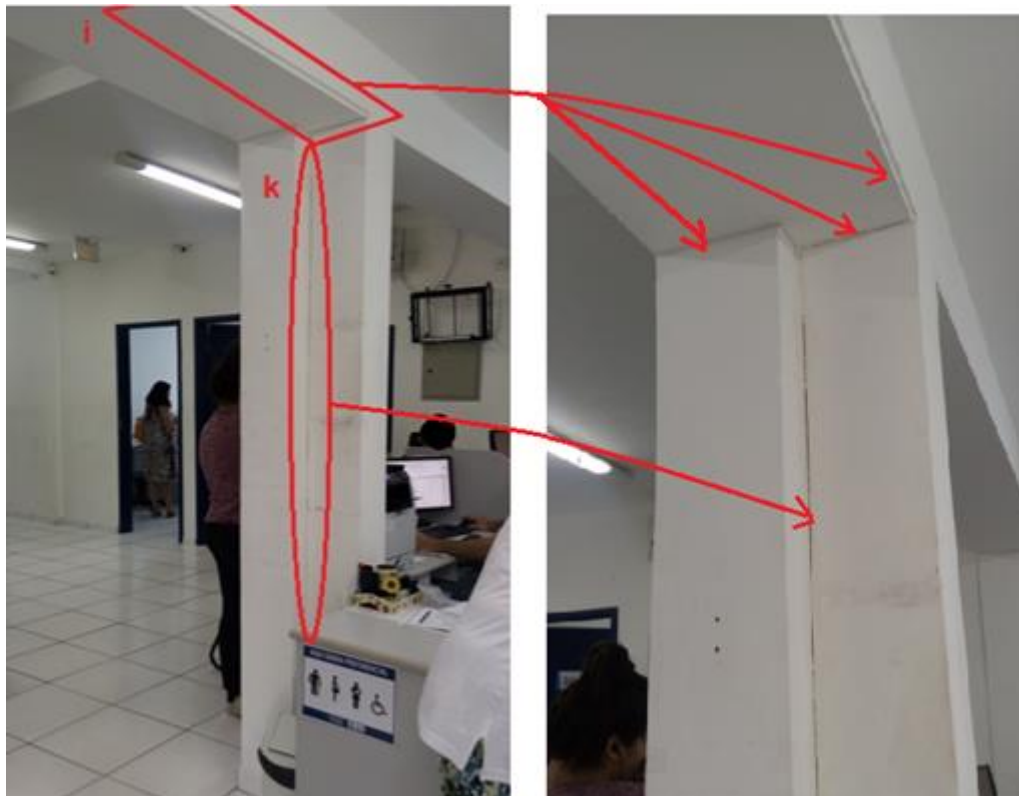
Junção entre a viga de concreto e a base de madeira realçada no detalhe "i" e "j"
